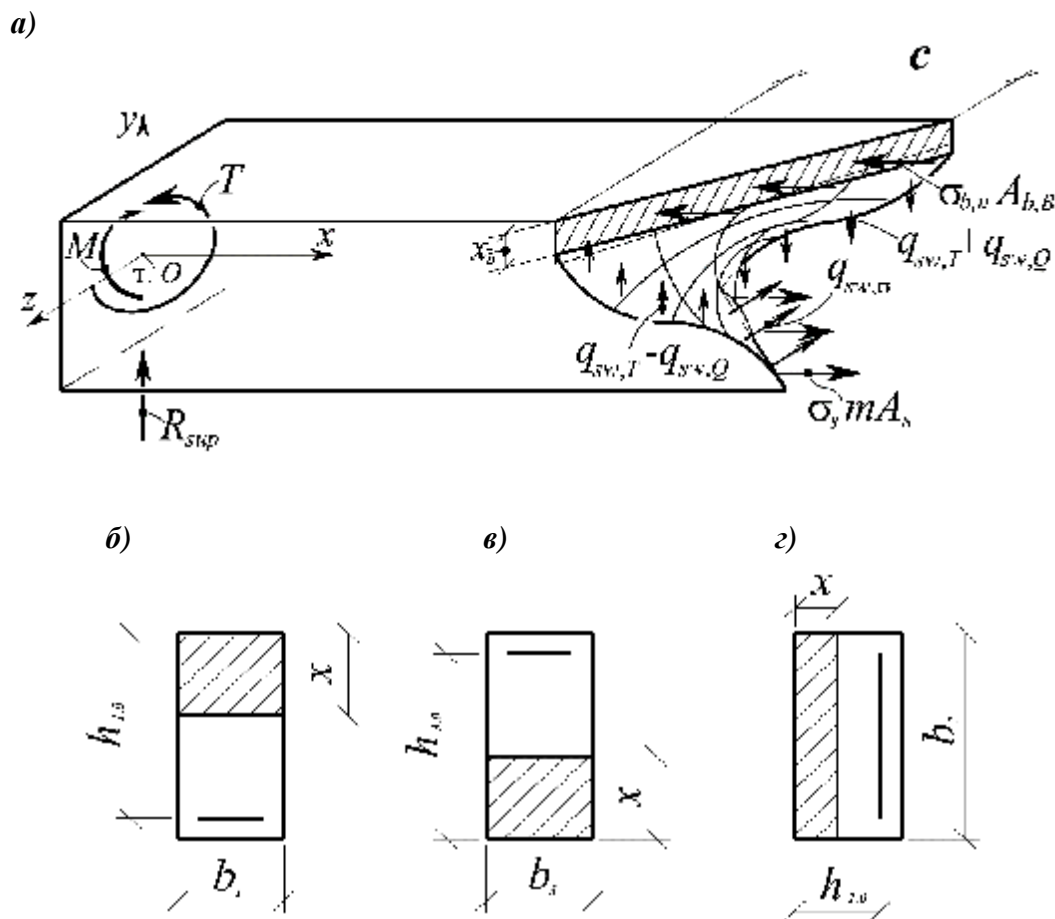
Усилия в пространственном сечении (а) и схемы (I,II,III) расположения сжатой зоны (б-г) в железобетонном элементе при изгибе с кручением
